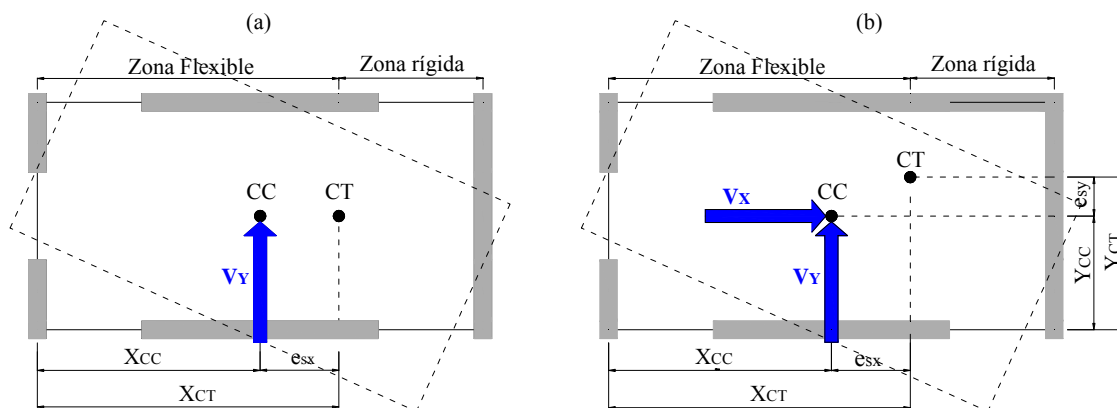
Identificación de zonas en planta uni-asimétrica (a) y planta bi-asimétrica (b)
